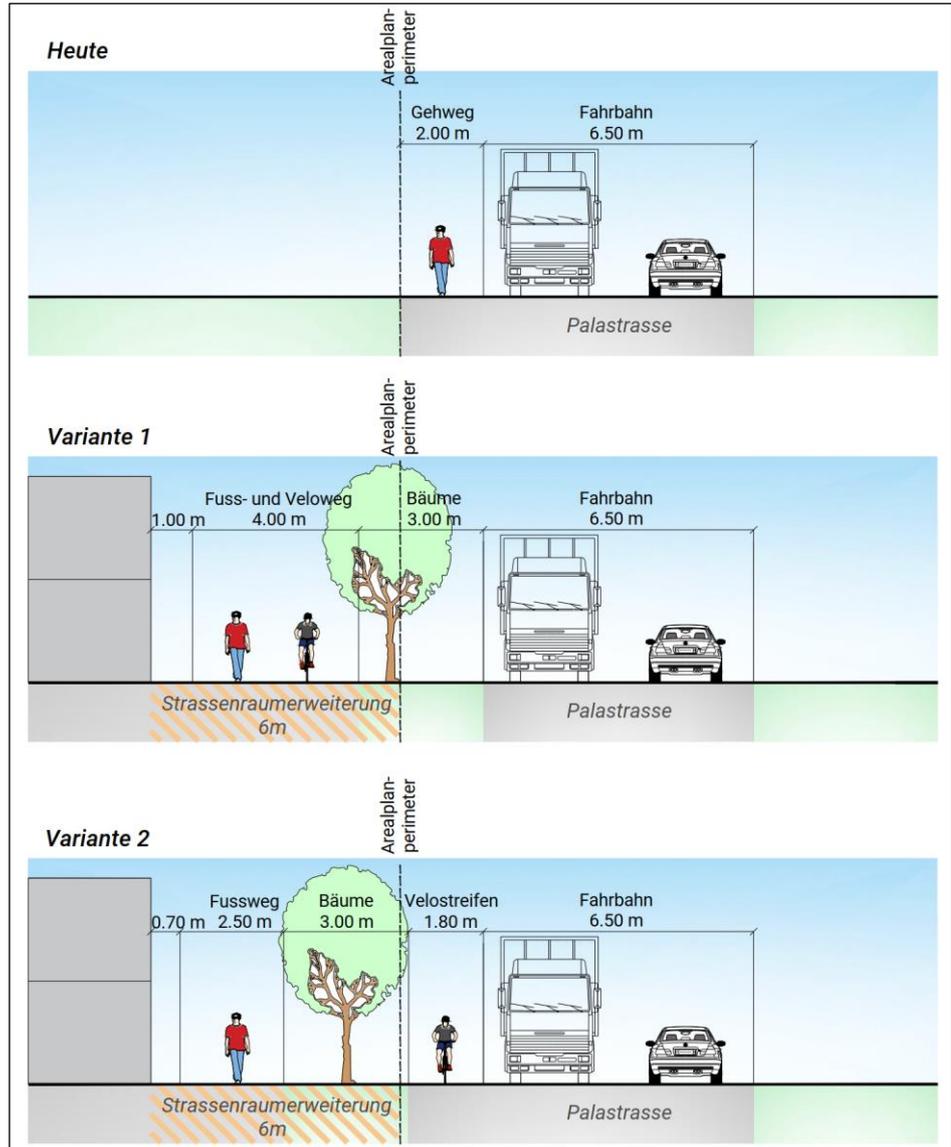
Mögliche Erweiterung und Aufwertung Strassenraum Palastrasse, Darstellung R+K
